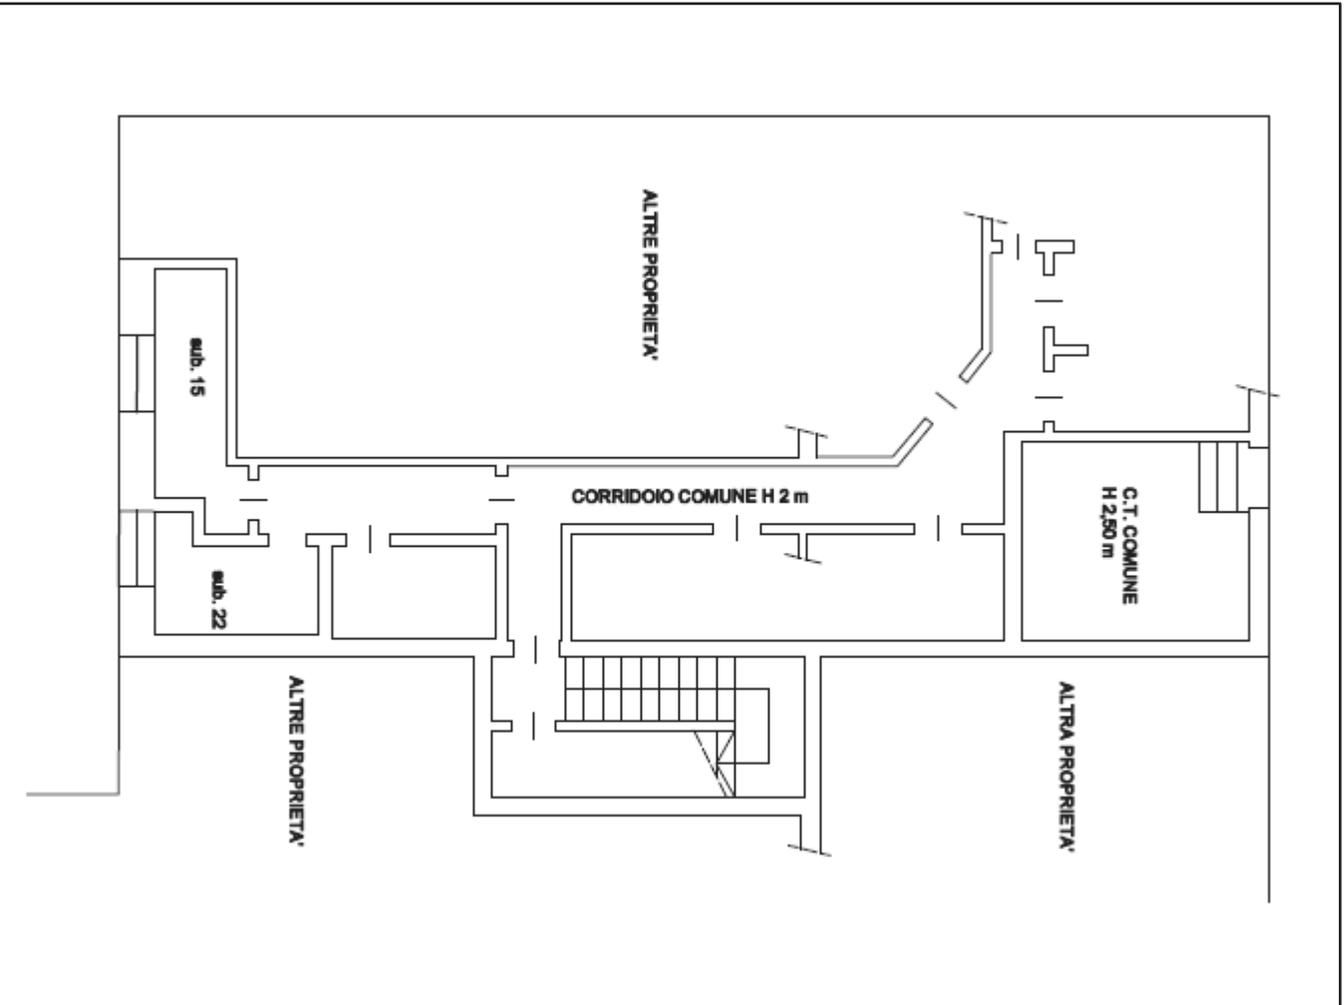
Rappresentazione del piano interrato tratta dalle planimetrie catastale
